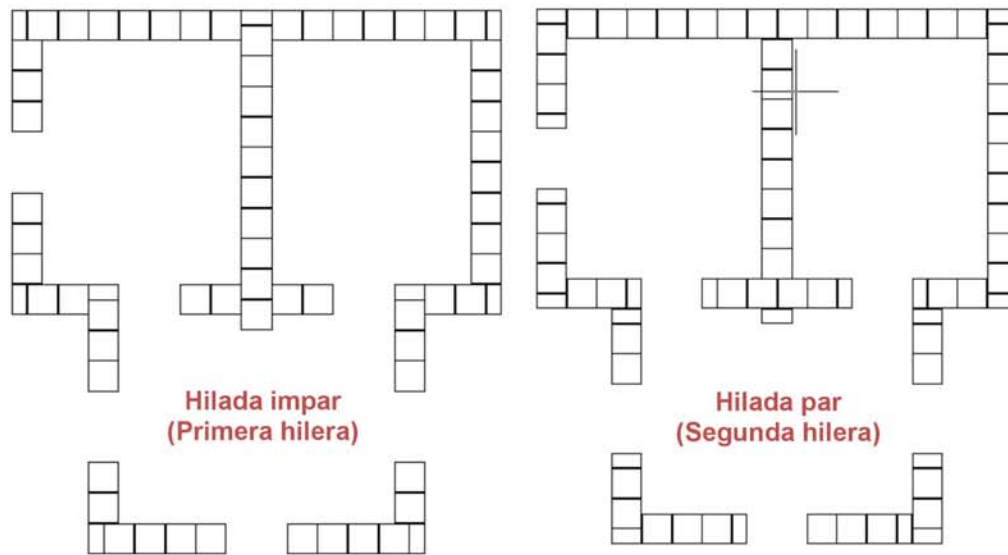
Emplantillado de hilada impar (izquierda) y par (derecha)
